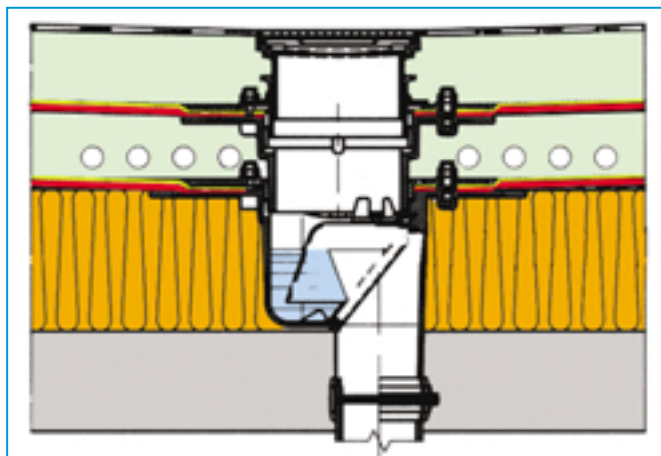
Bodenablauf mit Geruchverschluss und seitlichem Zulauf im Bodenaufbau mit Abdichtung durch Dichtungsbahn
